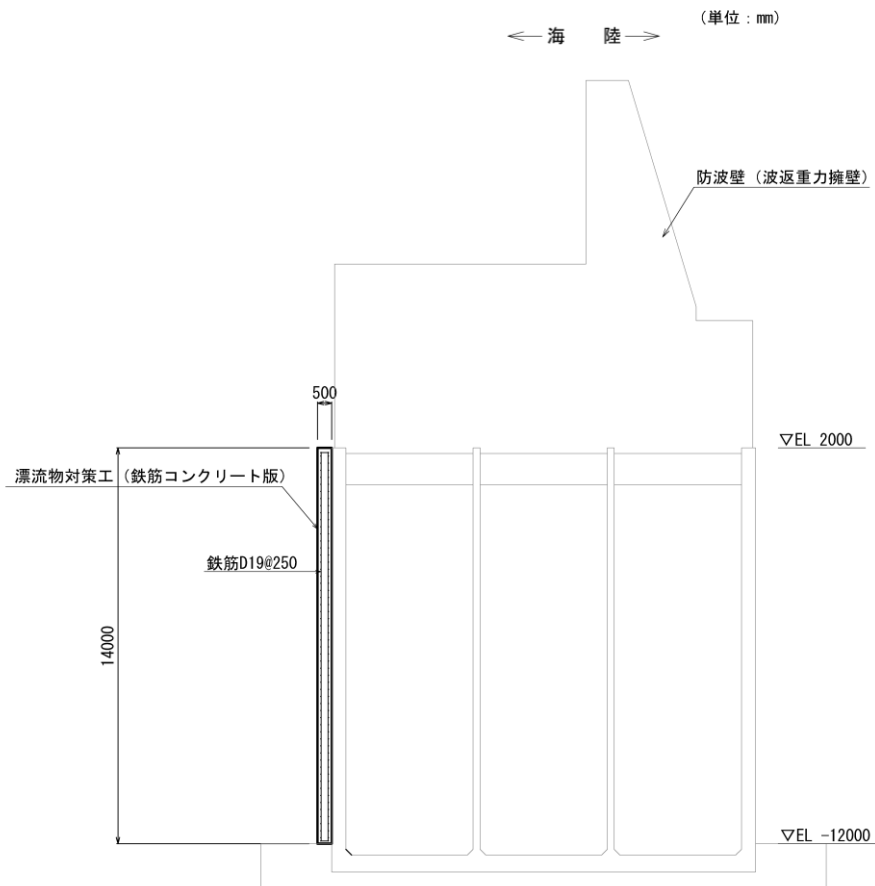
(4) 防波壁（波返重力擁壁）ケーソンにおける漂流物対策工（鉄筋コンクリート版）の概略配筋図（断面図）
